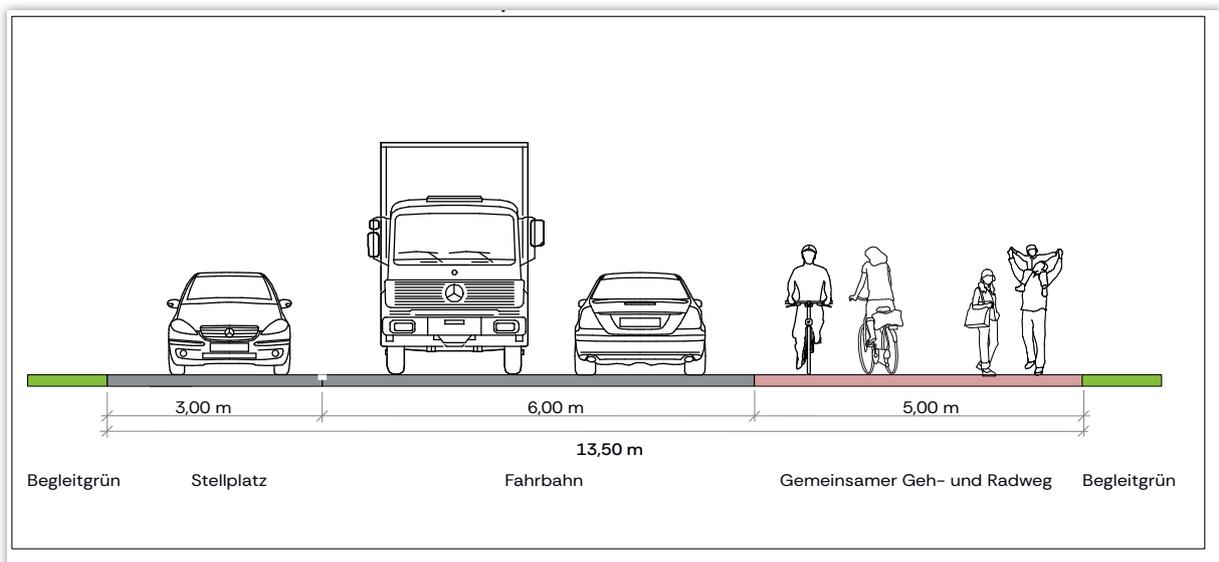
Querschnittsentwurf Hauptstraße Höhe der Ein- und Ausfahrt des Plangebiets
